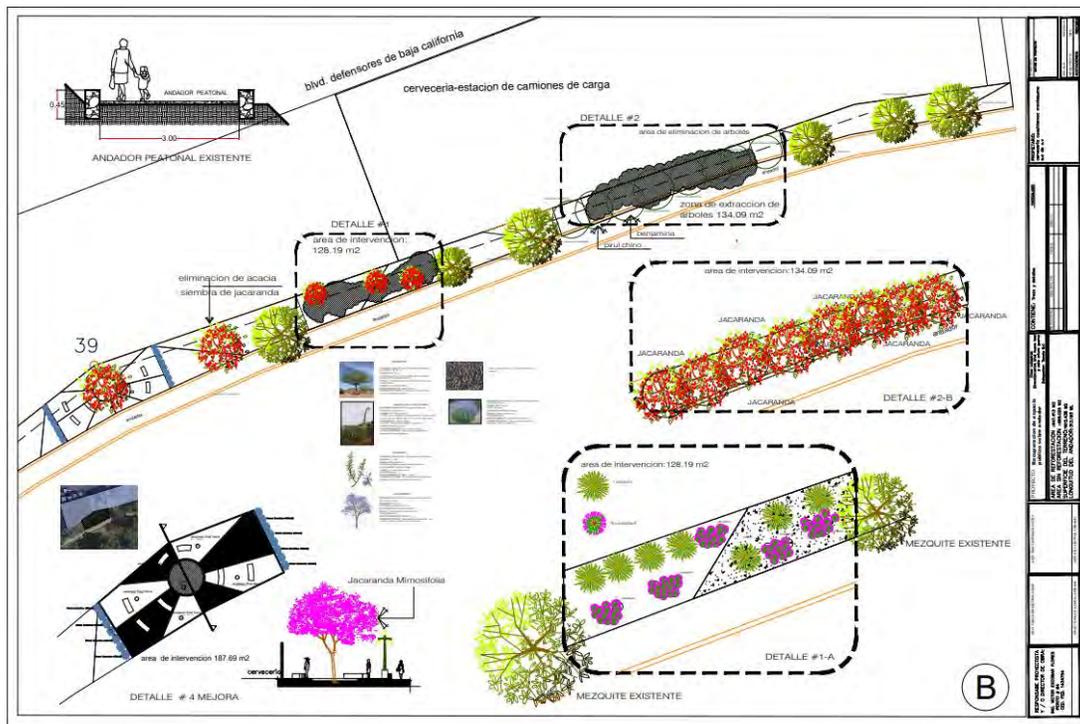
Plano B: Plano de reforestación del área de andador sección A
